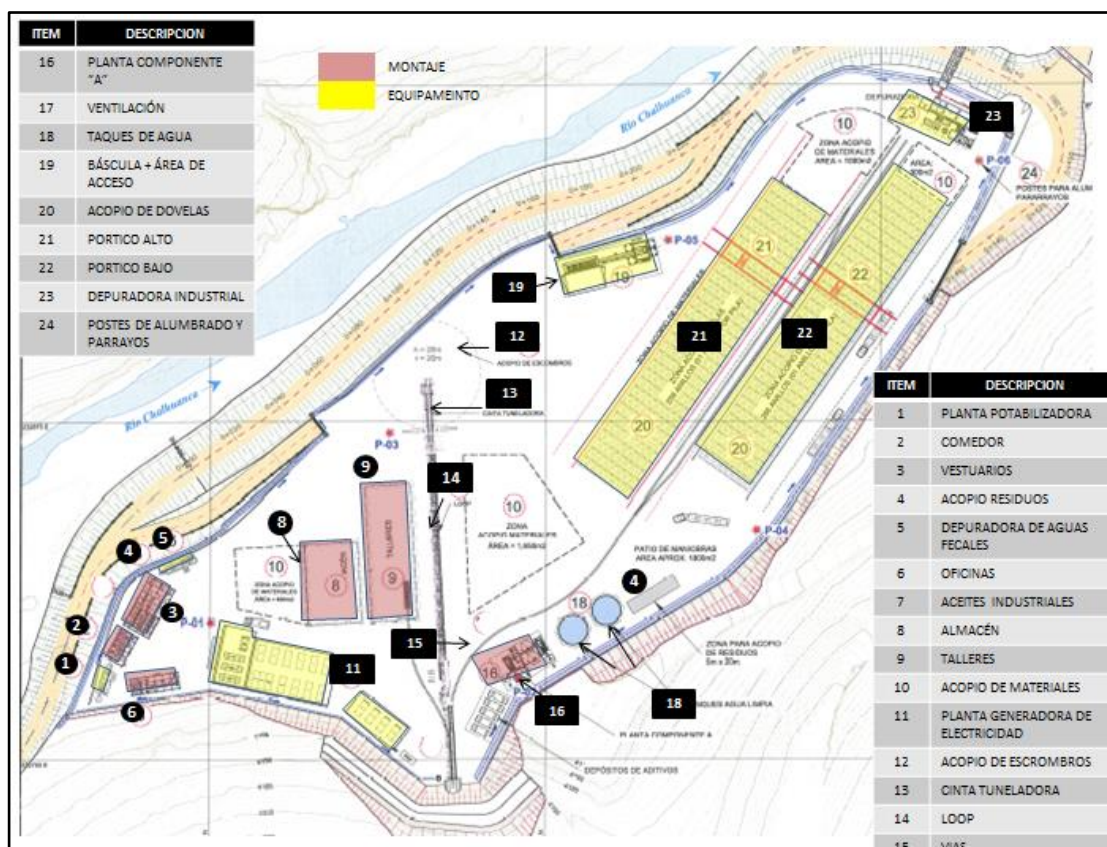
Planta de las instalaciones de la plataforma Chaluwanka
